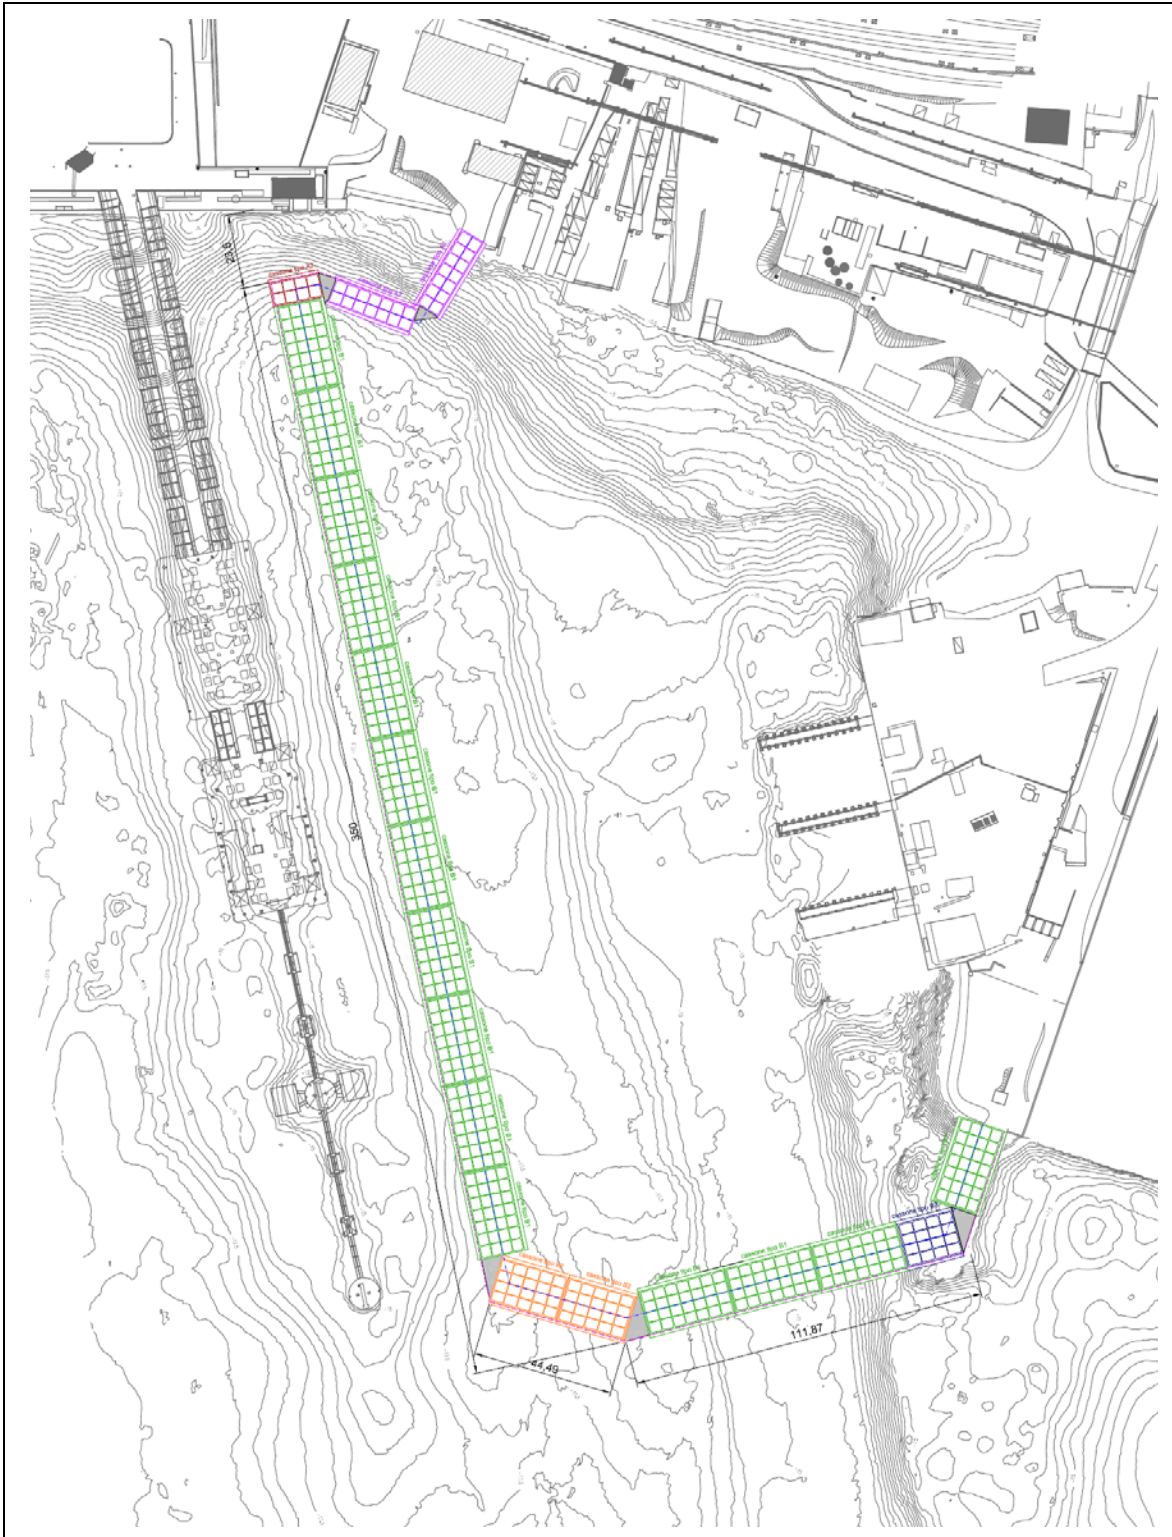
Estratto della planimetria di progetto della nuova colmata (disposizione dei cassoni perimetrali)
